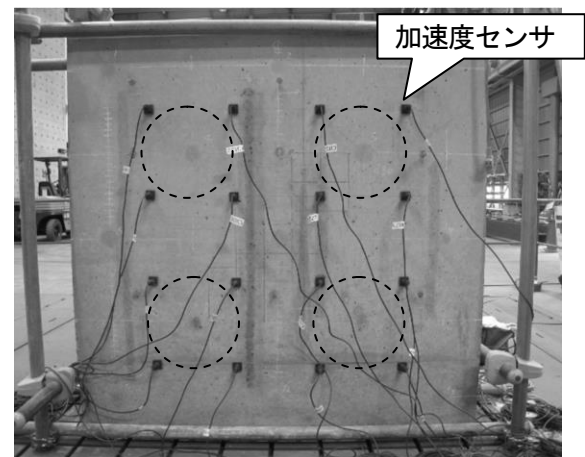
センサ配置状況（破線は模擬欠陥部位）
